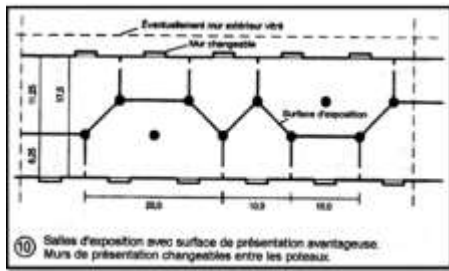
salles d'exposition avec surface de présentation avantageuse. Murs de présentation changeables entre les poteaux
